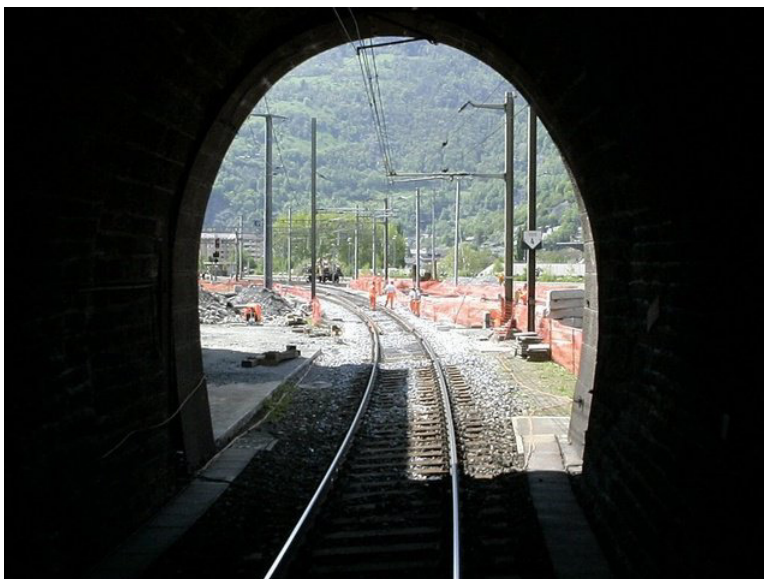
Simplontunnel, typisches Tunnelprofil mit gewölbten Paramenten
